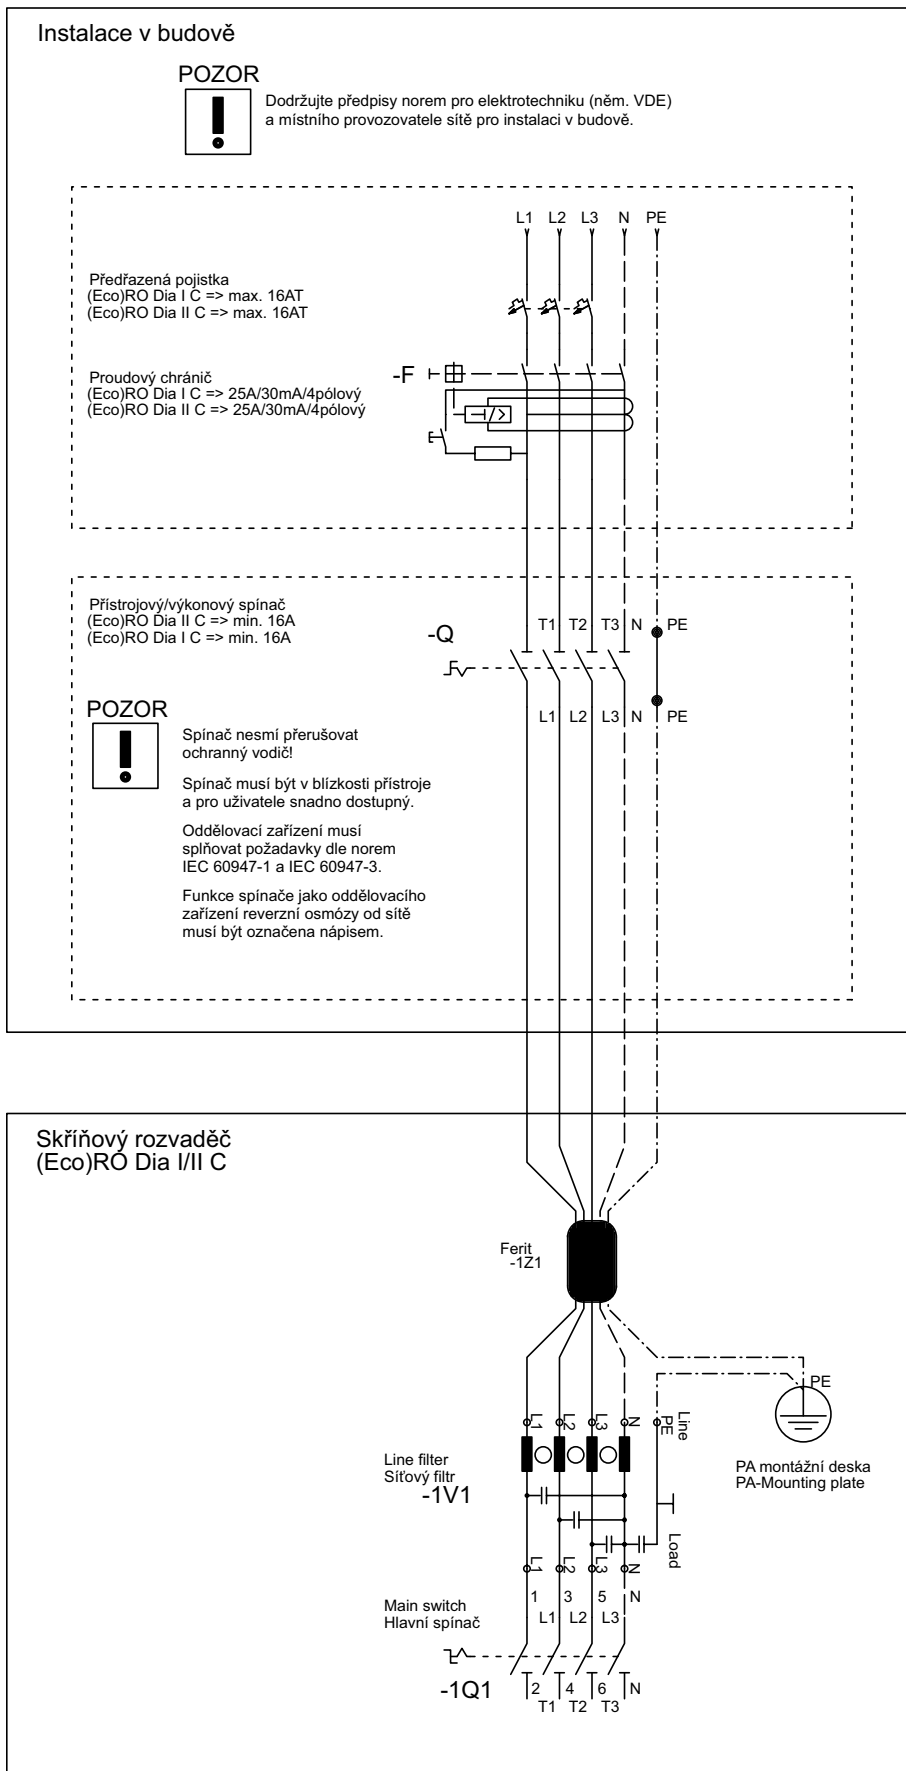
Plán instalace (Eco)RO Dia II C
